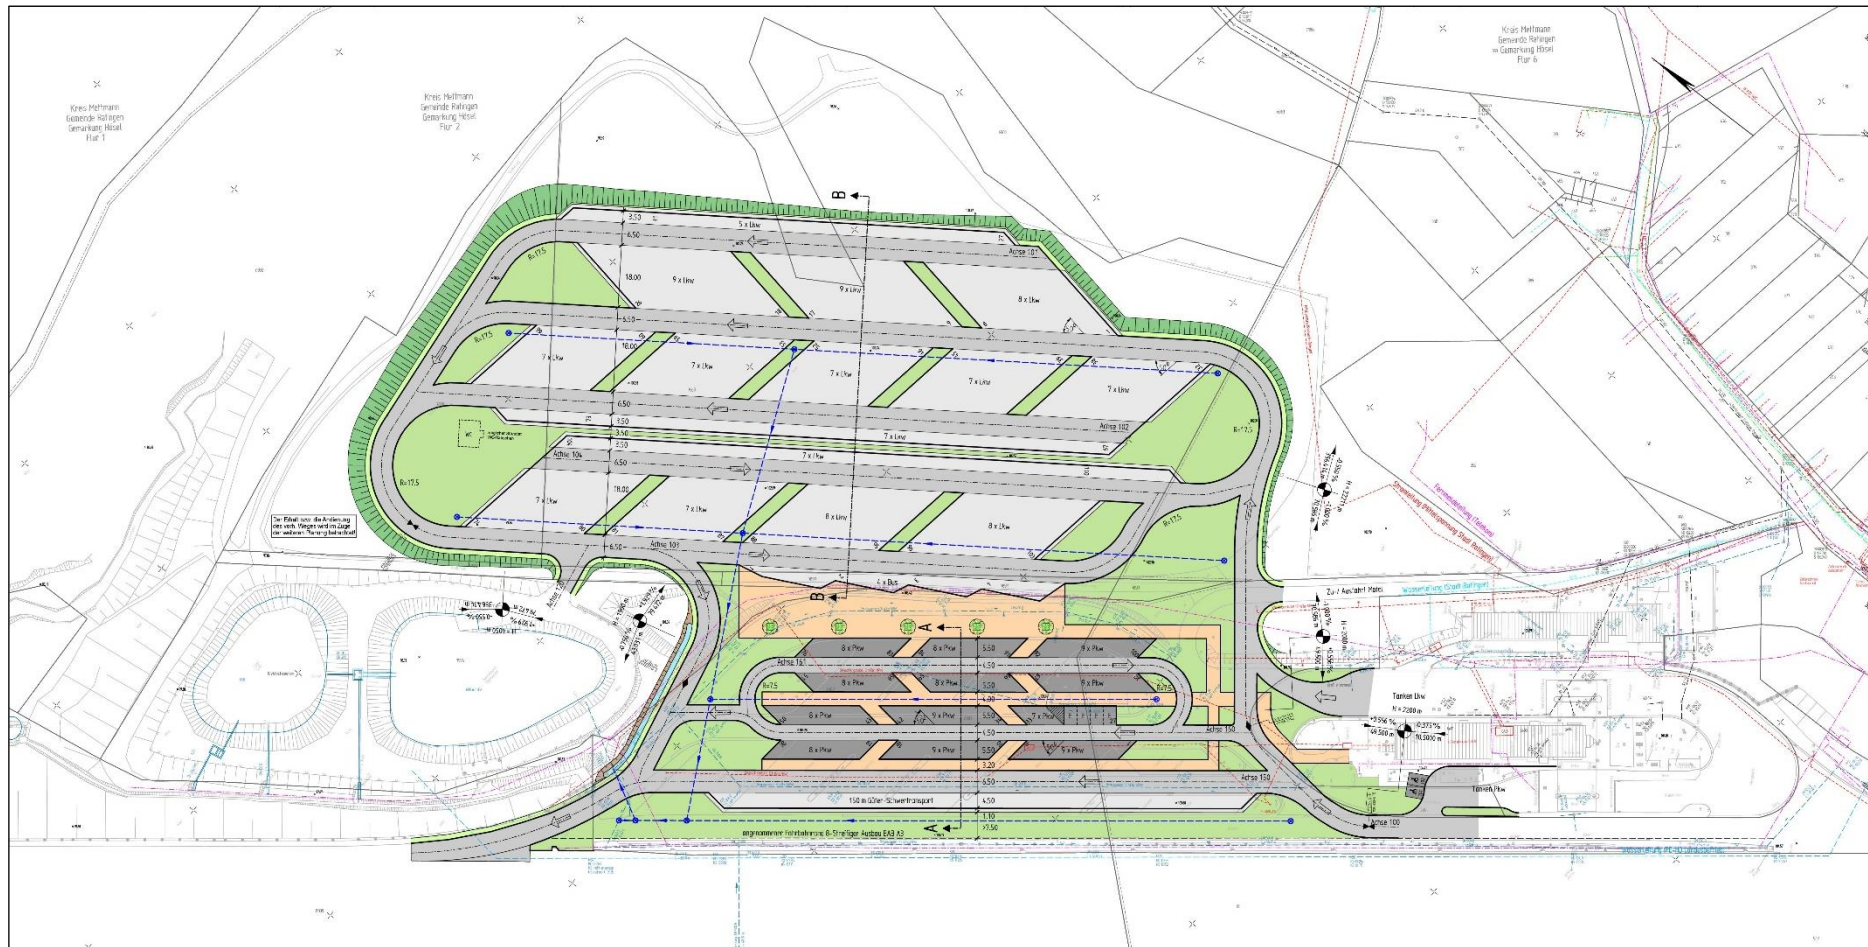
Lageplan der Variante 1 (Quelle: INGENAIX GmbH 2018)
